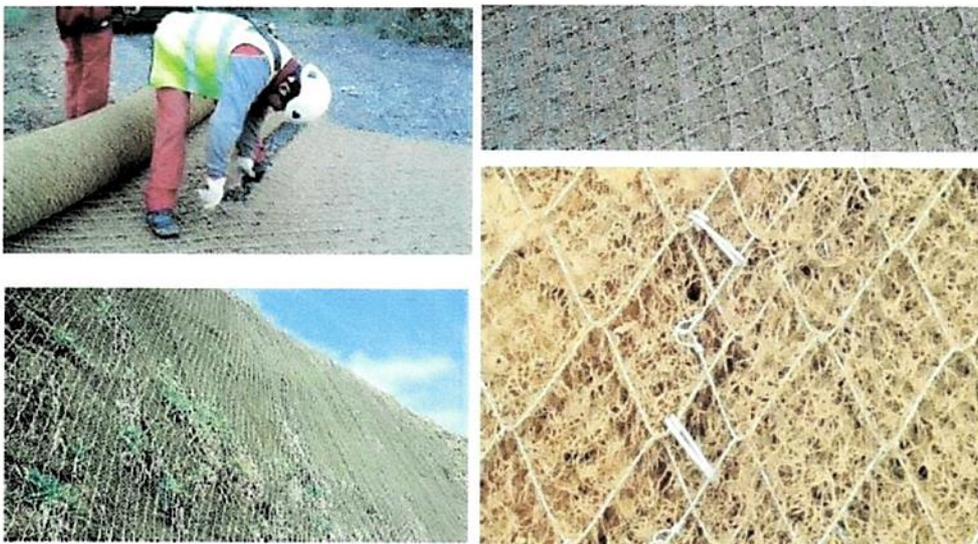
caratteristiche rete di protezione (elab. OP.04)
